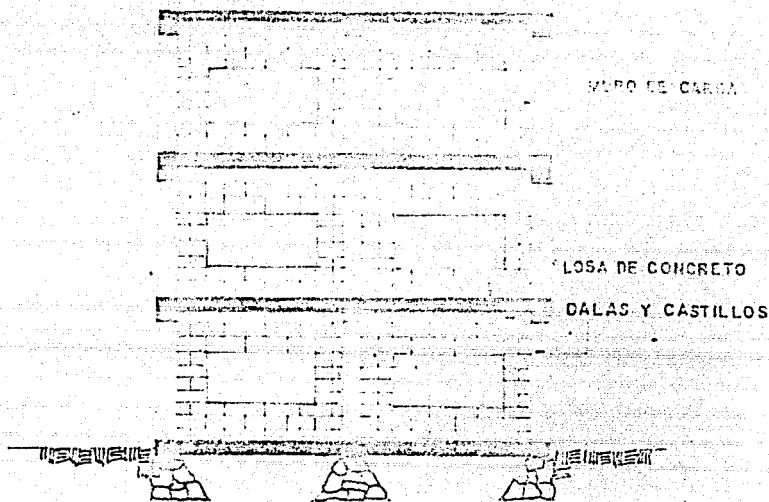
Modelo de una estructuración antigua realizada en mampostería. Tomado de Del Valle, C.E., Comportamiento de las estructuras, Revista Mexicana de la Construcción No. 347, p. 38.
